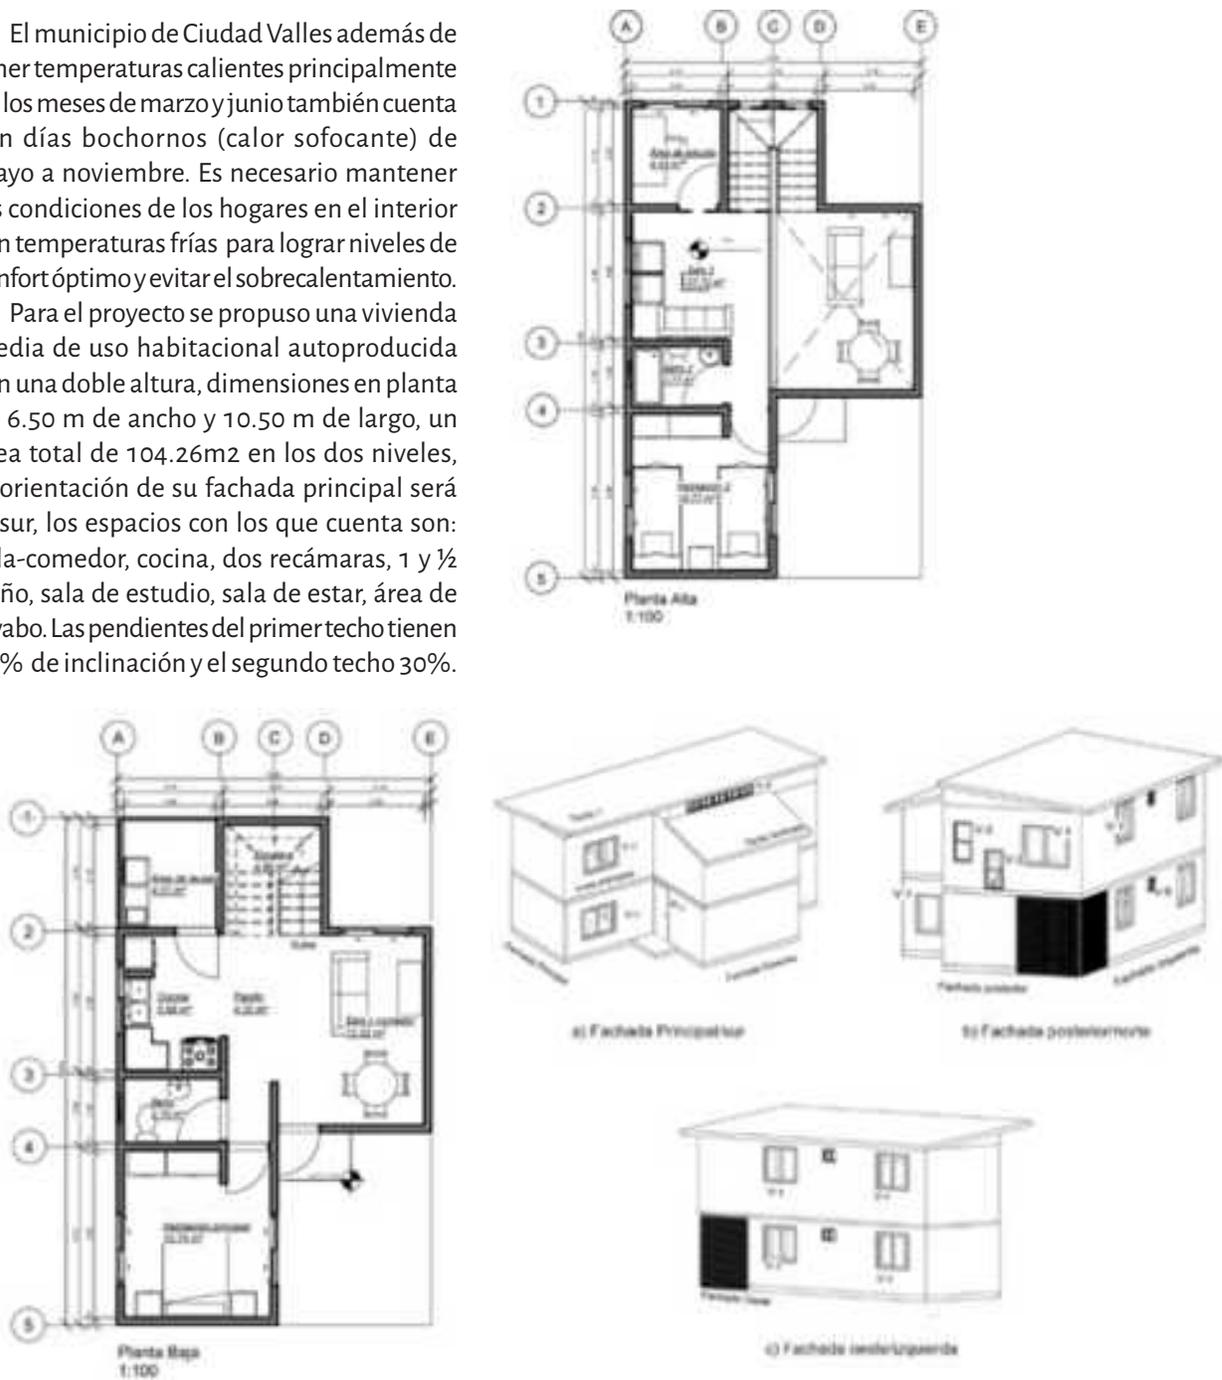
Planos arquitectónicos de la vivienda propuesta.
